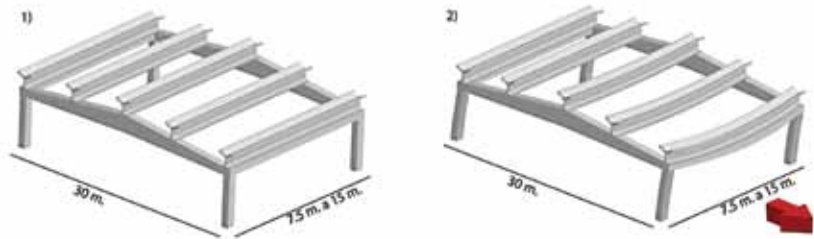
Esquema de volcamiento de viga secundaria tipo Tau.
